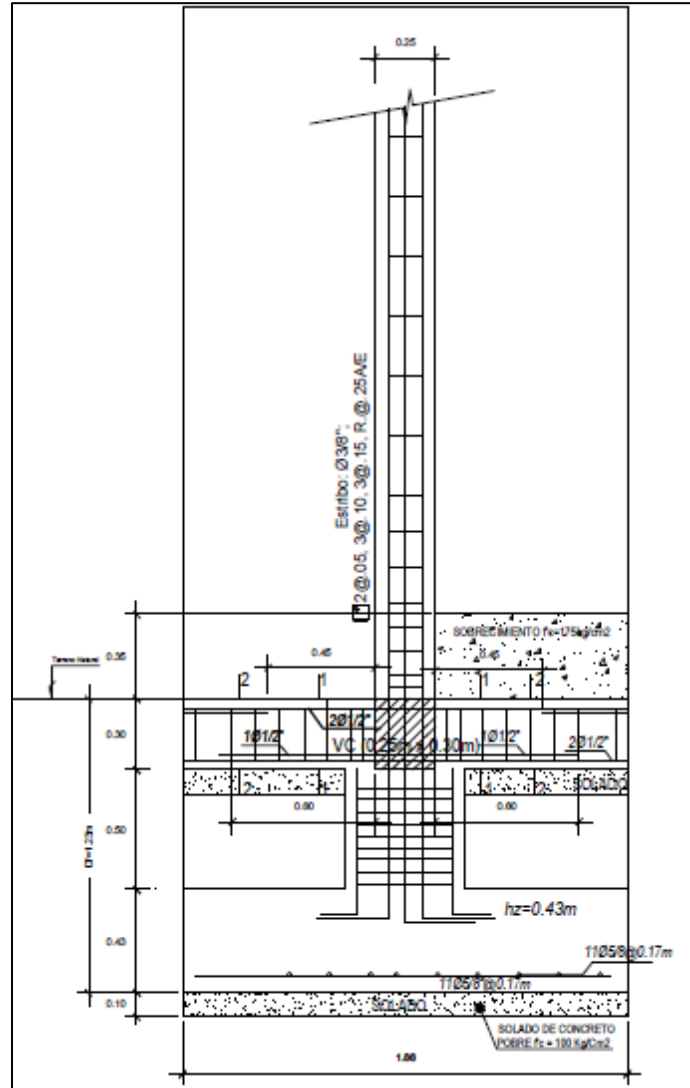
Detalle de zapata típica cuadrada. Edición: Elaboración propia.
